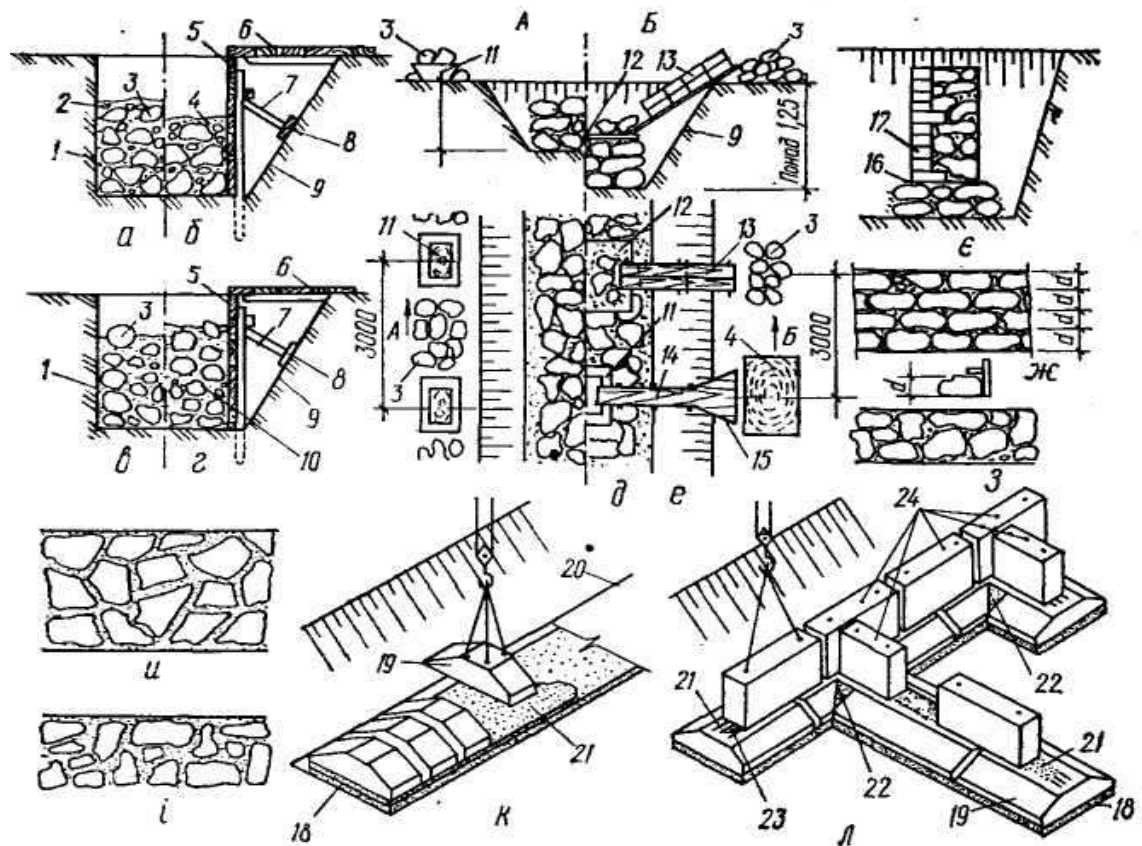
Зведення конструкцій підземної частини будівлі із бутового каменя і великих бетонних блоків:
